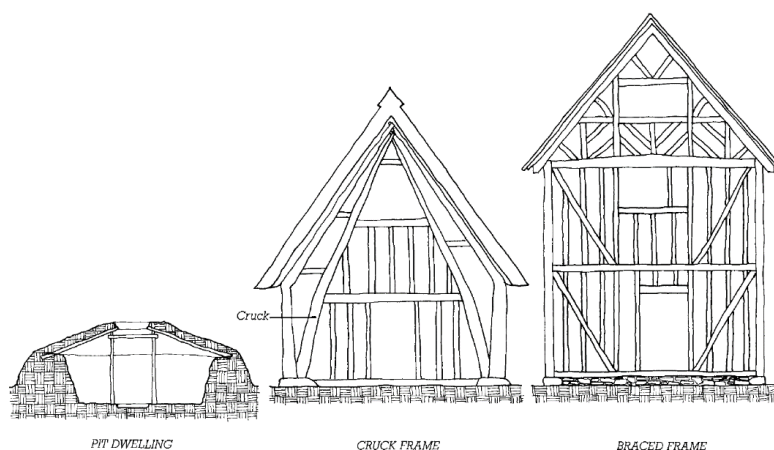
Explicação funcional da evolução da construção em madeira, baseada no aumento de pisos (Allen & Iano, 2008).
